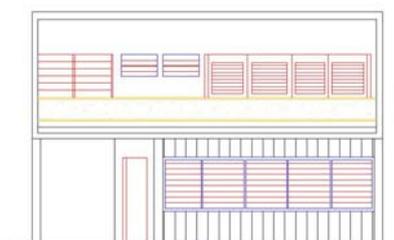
Croqui Fachada Original – Res. Alfredo Fonseca
